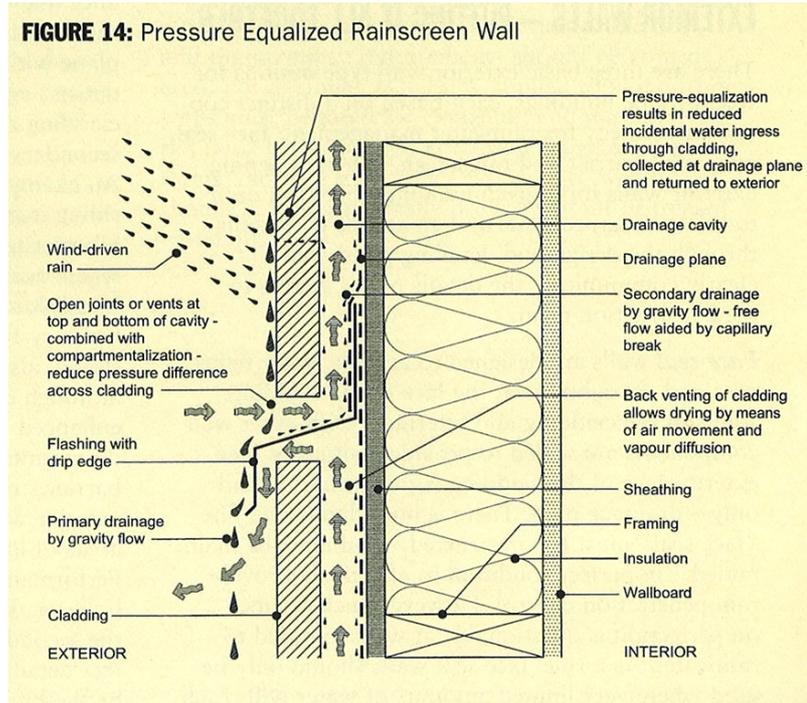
Detalhe da parede. Sistema Rainscreen Wall.
